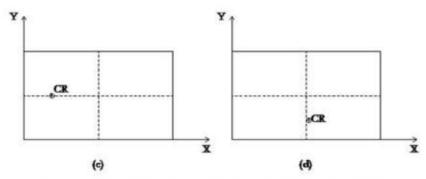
Esempio di simmetria della distribuzione della rigidezza rispetto alla direzione x e non alla direzione y (c) e viceversa (d).
